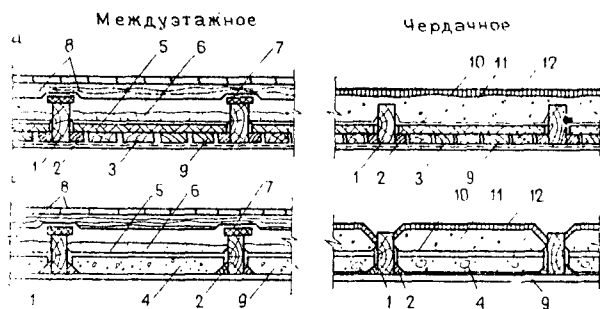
Перекрытия по деревянным балкам с накатом: а — из деревянных щитов; б — из гипсобетонных плит; 1 — балки; 2 — черепные бруски; 3 — щиты из досок; 4 — гипсобетонные плиты; 5 — известковая или глиняная смазка; 6 — усиление изоляции воздушного шума (песок); 7 — изоляция ударного шума (упругие прокладки); 8 — пол по лагам; 9 — сухая штукатурка; 10 — пароизоляция (глиняная смазка); 11 — теплоизоляция; 12 — стяжка
